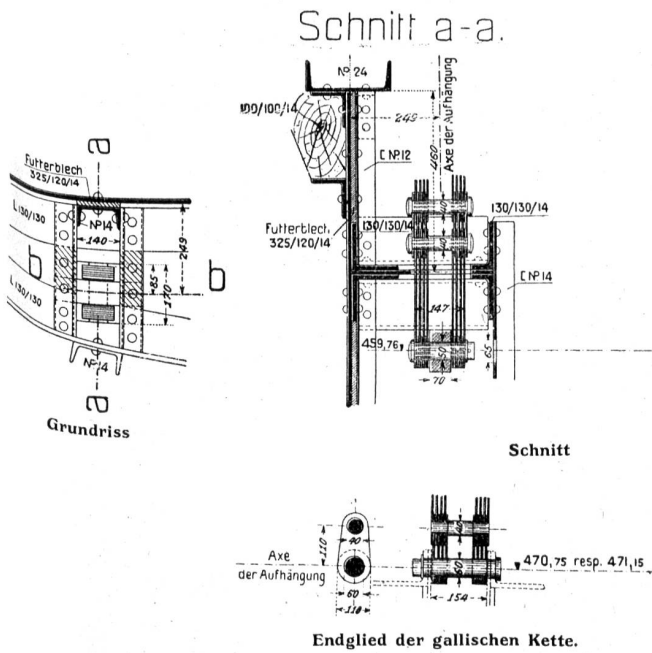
Details der Aufhängung der untern Grundablass-Schützen. Maßstab 1 : 20.
